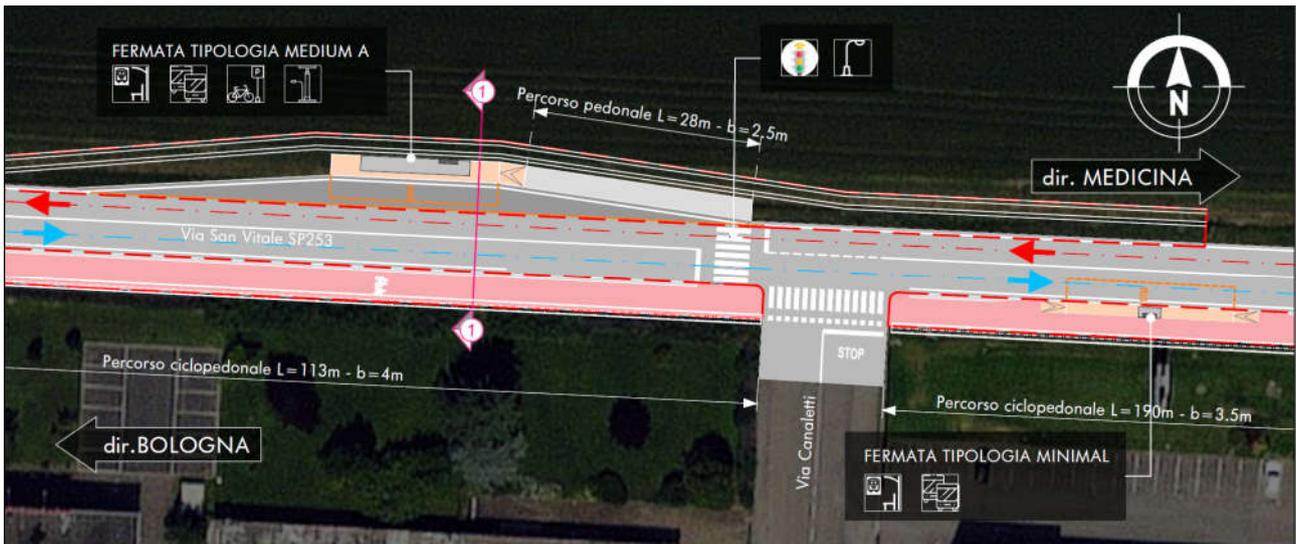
Fermata Canaletti. Focus Planimetria.
